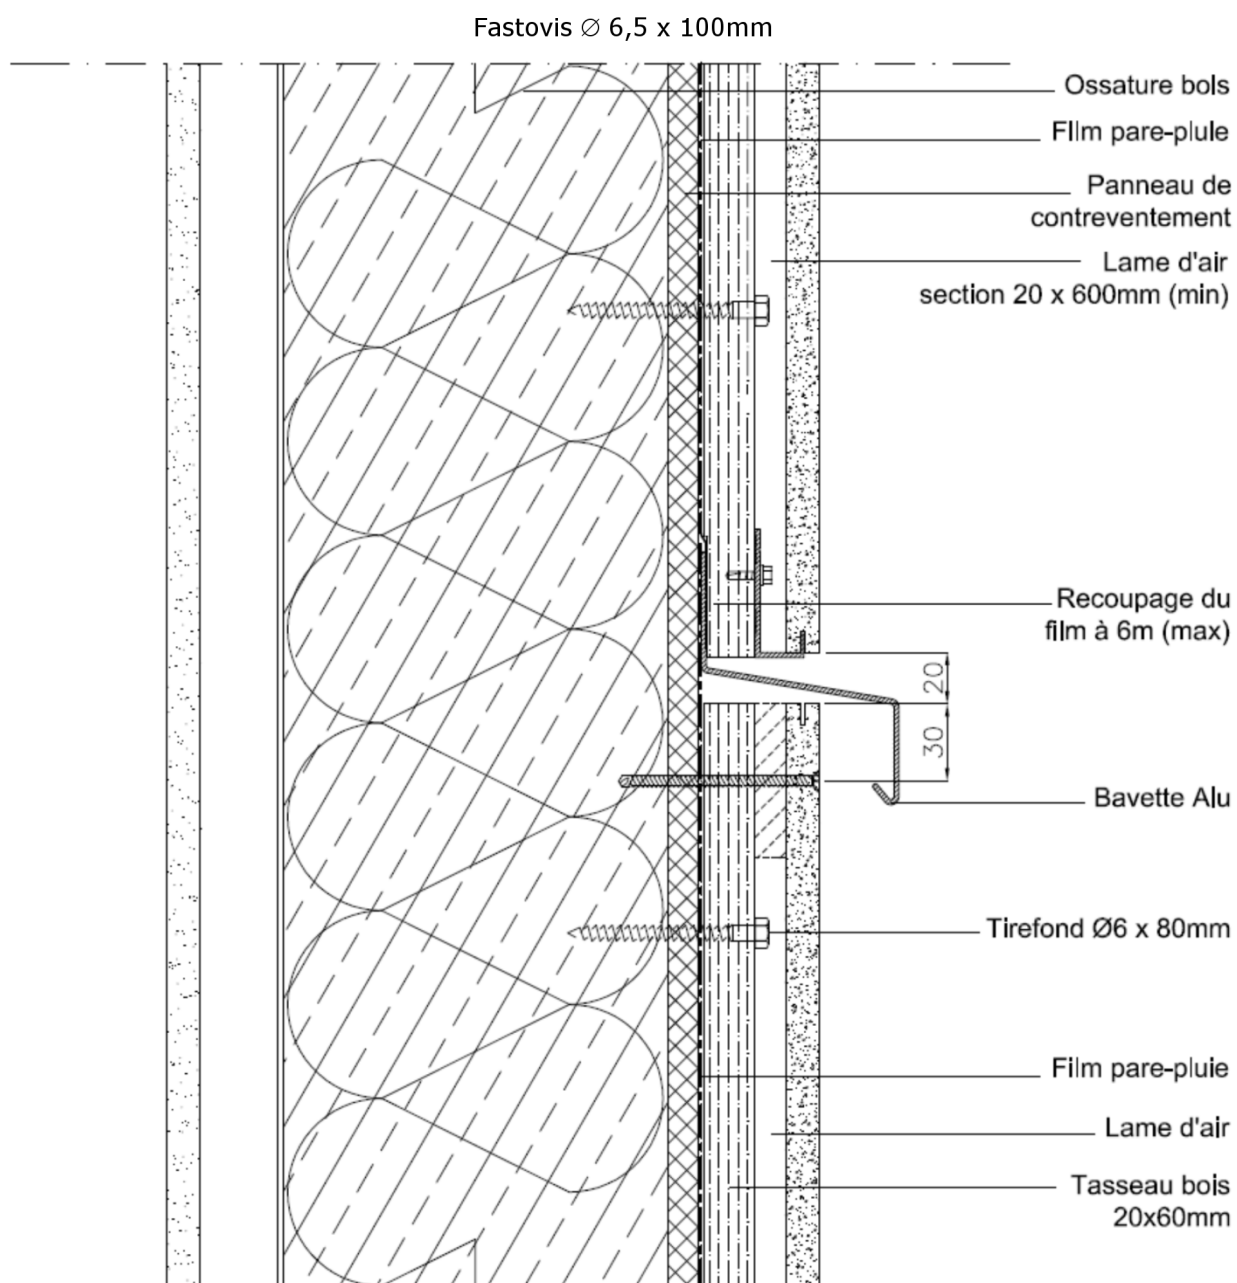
Recoupement du pare-pluie tous les 6 m sur COB
